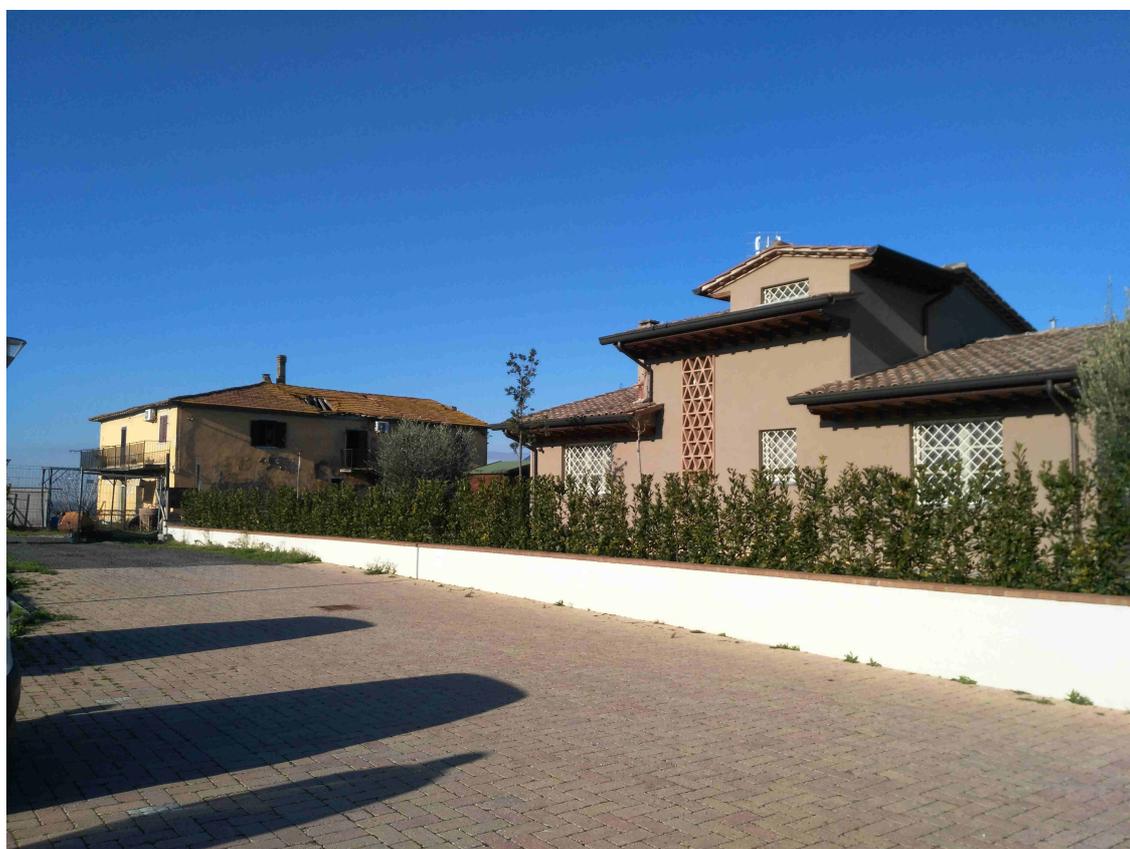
Edificio schedatura n.62 - Presa fotografica esterna da “corte Poggerello”
